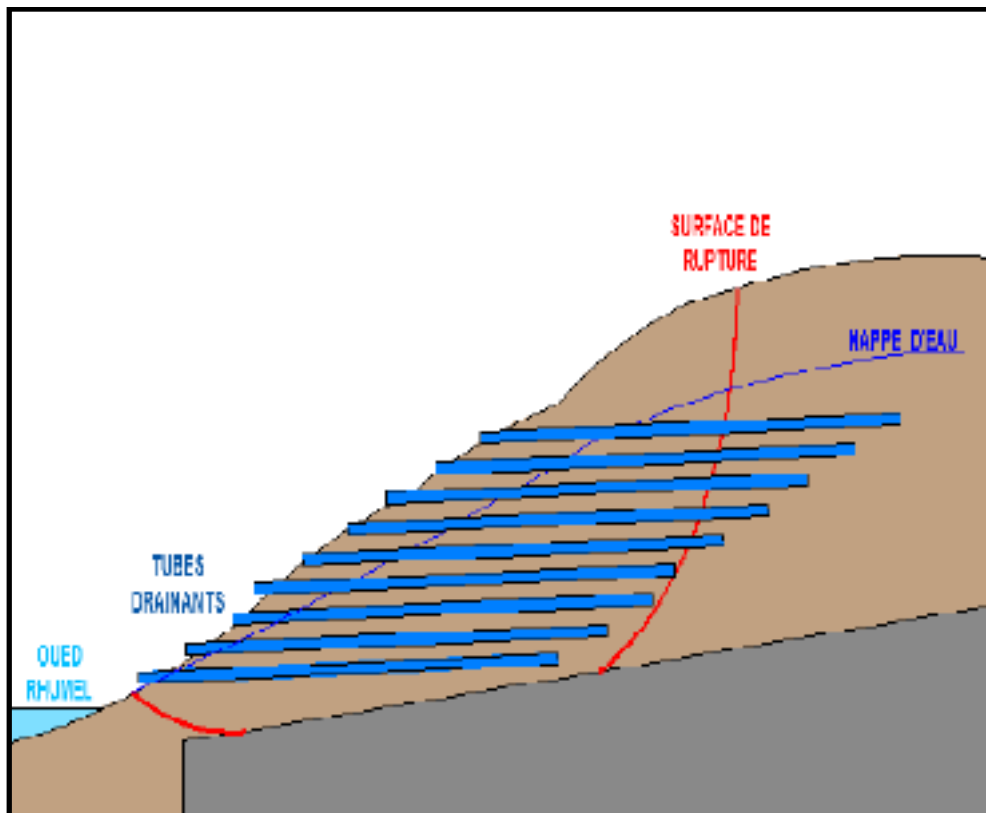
Schéma de drainage par tubes subhorizontaux
